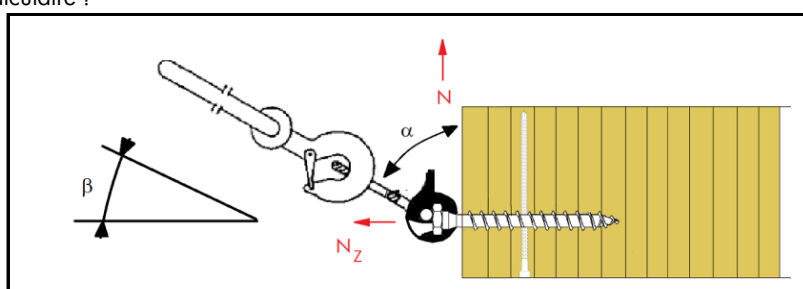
Emplacement des points d'ancrages sur le chant de la dalle (pas applicable en bois de bout)
